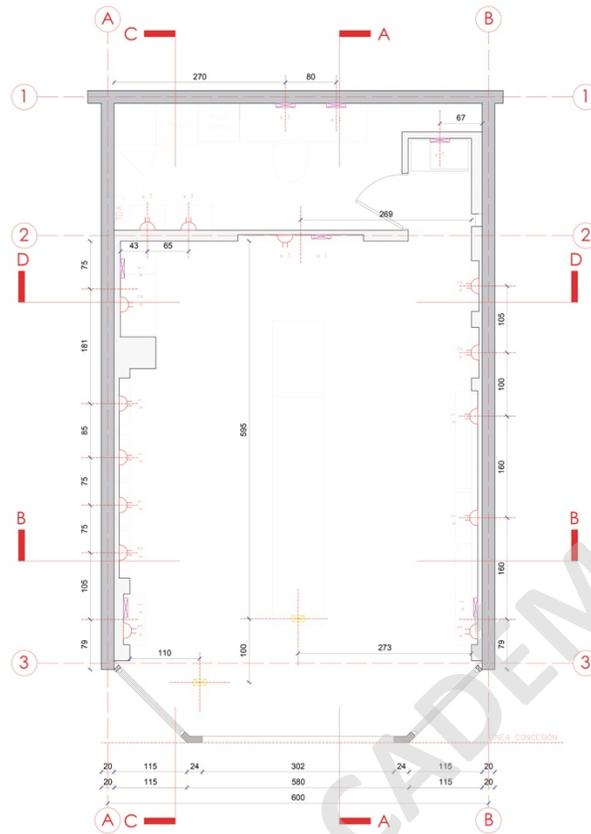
Manual de construcción - Planta Requerimientos Eléctricos.
